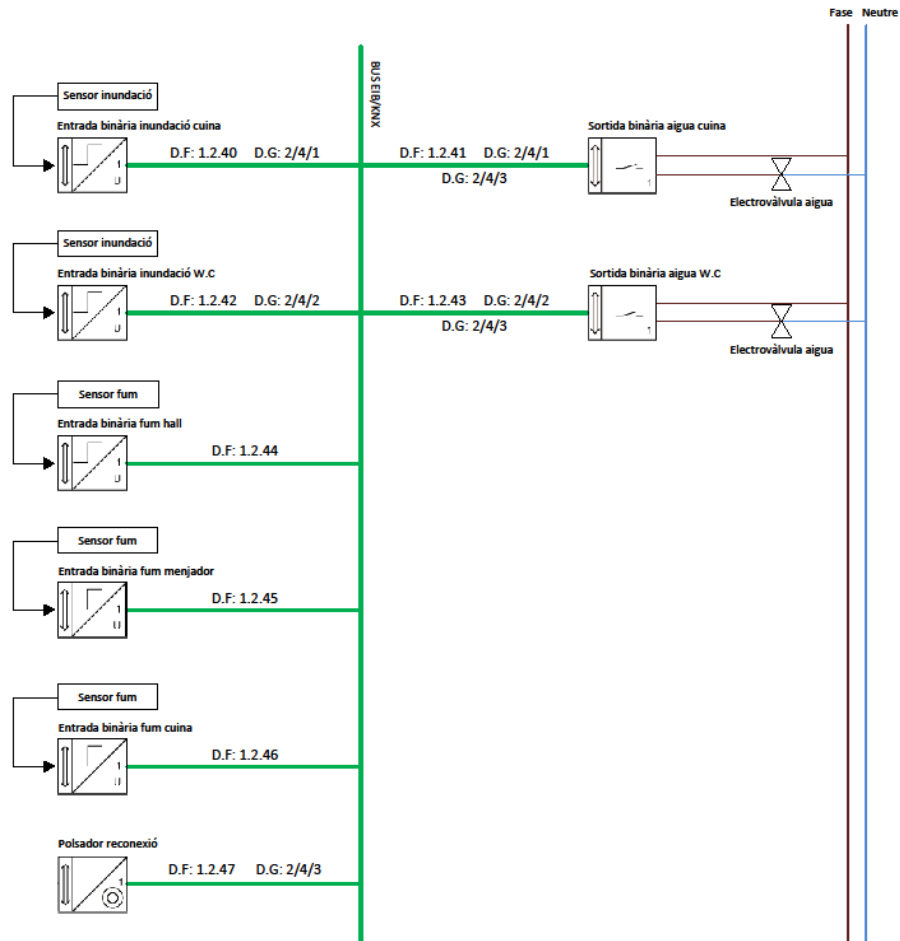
Esquema domòtic de seguretat planta baixa
